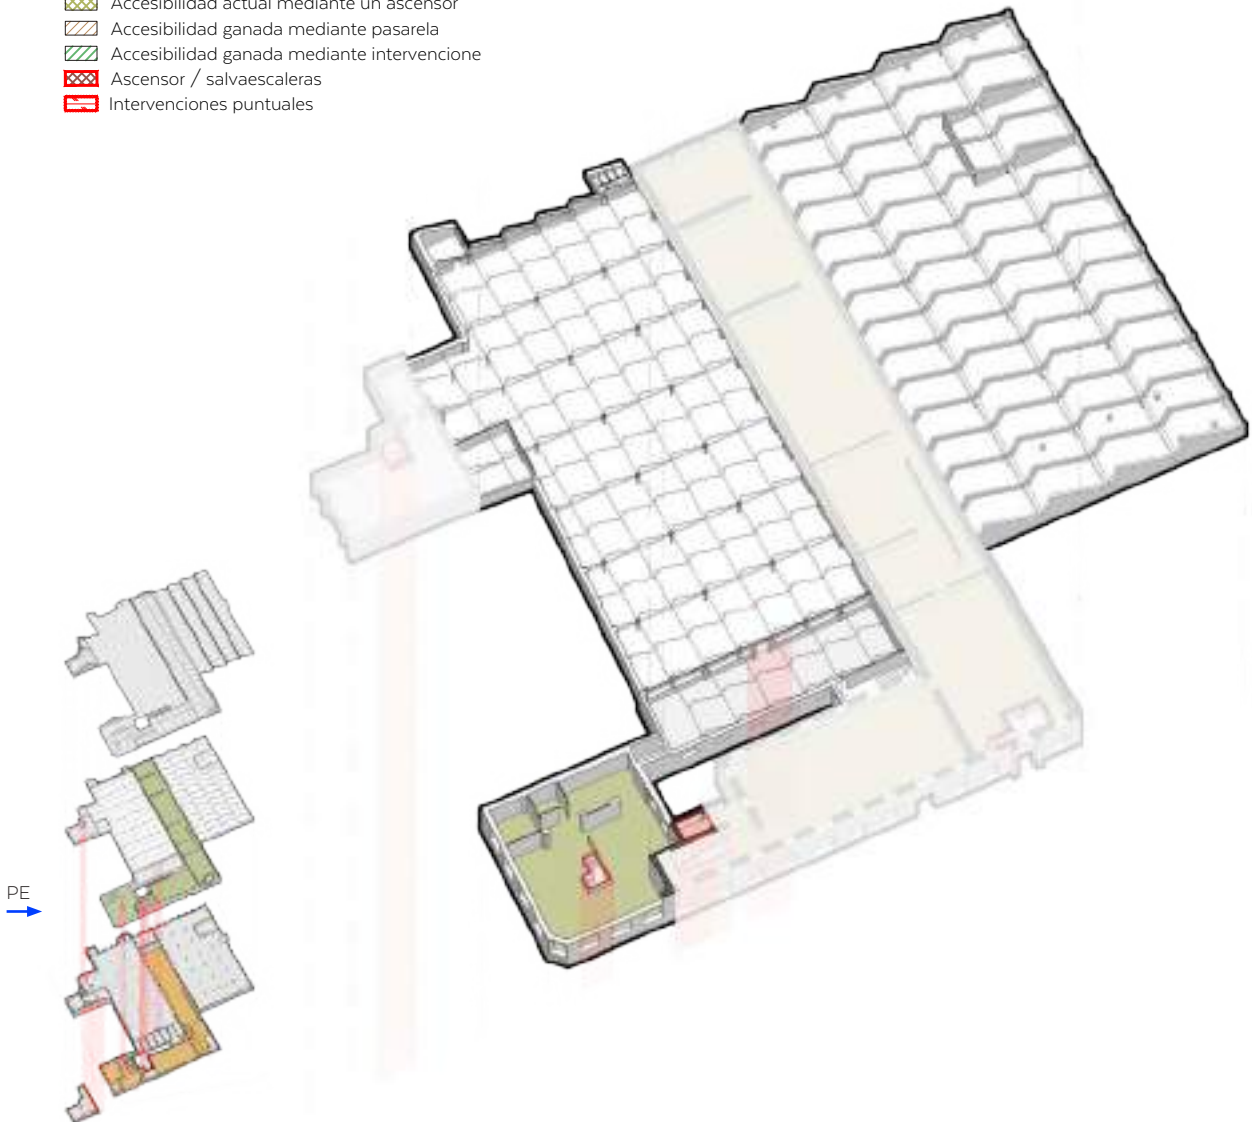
Accesibilidad actual. Axonometría de la entreplanta
